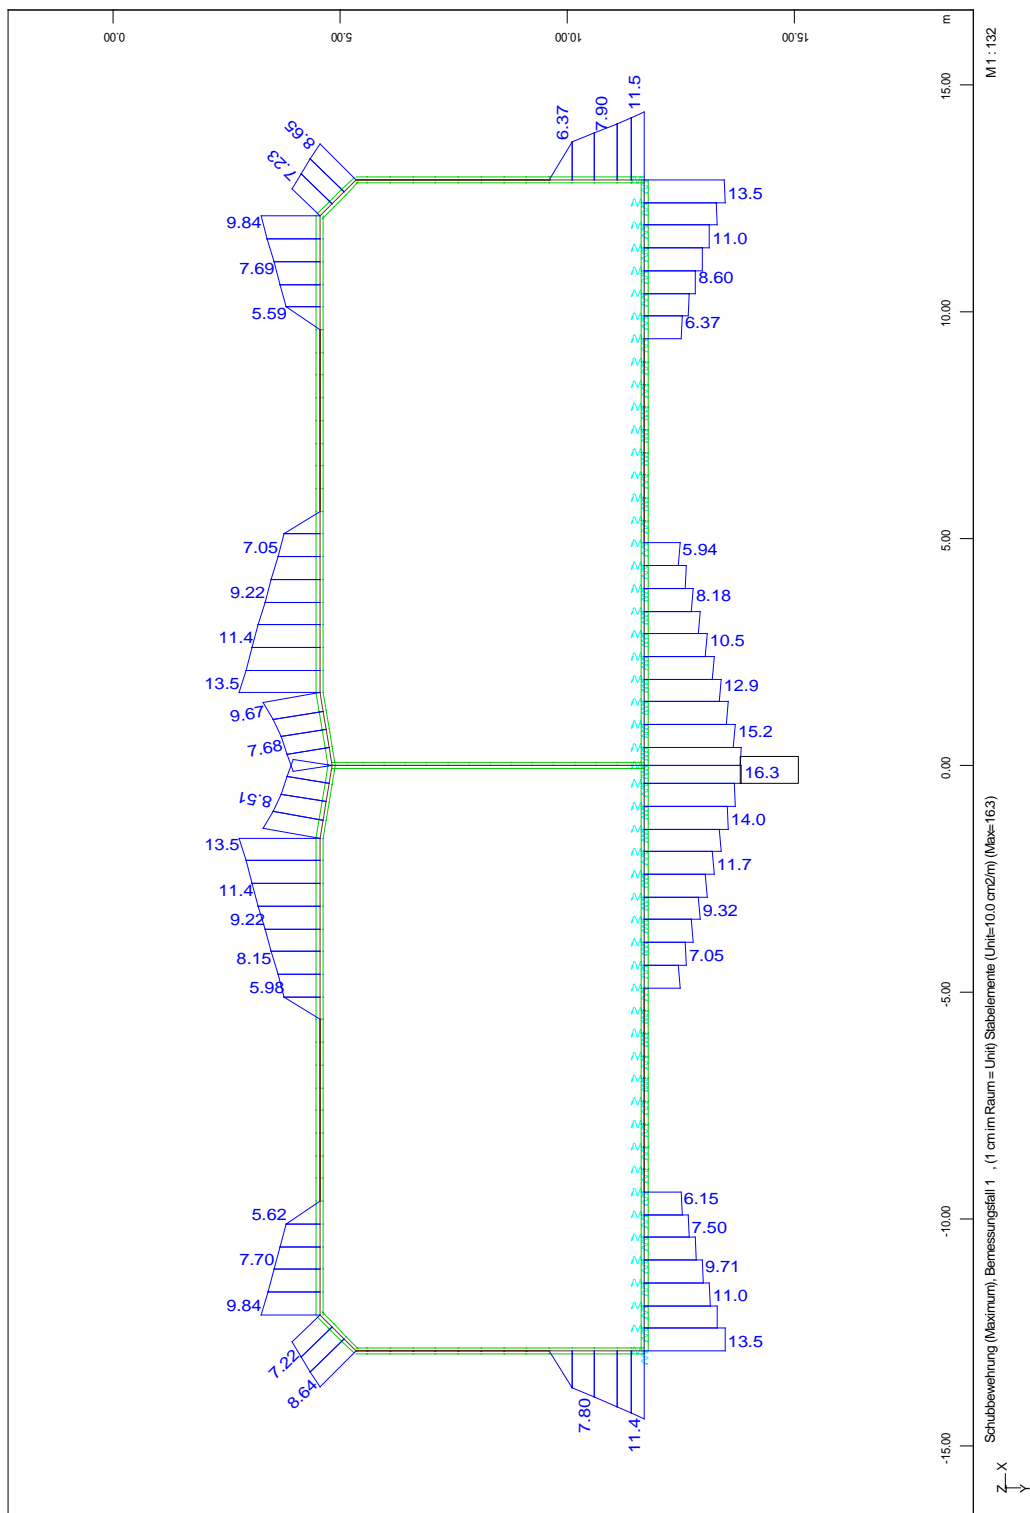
Schubbewehrung, ständige und vorübergehende Bemessungssituation
